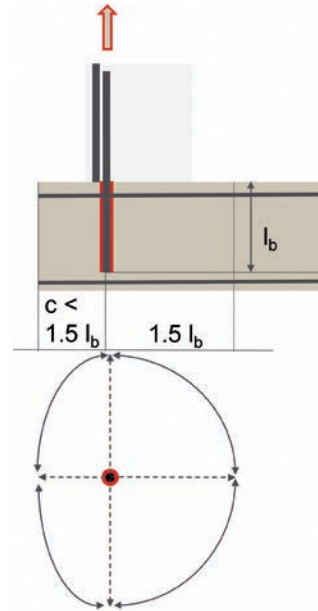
Einfluss des Rands auf den Kräfteverlauf im Bereich eines durch eine Zuglast beanspruchten, nachträglich eingemörtelten Bewehrungsstabs (schematisch)
